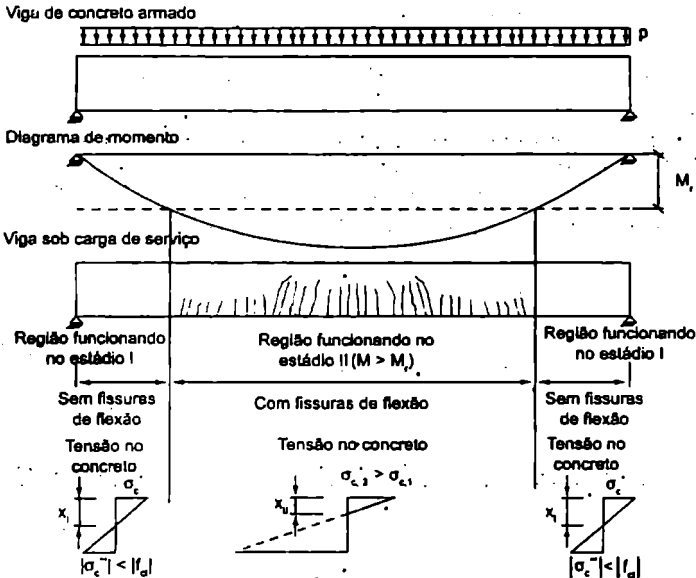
Viga de concreto armado simplesmente apoiada sob ações de serviço.
